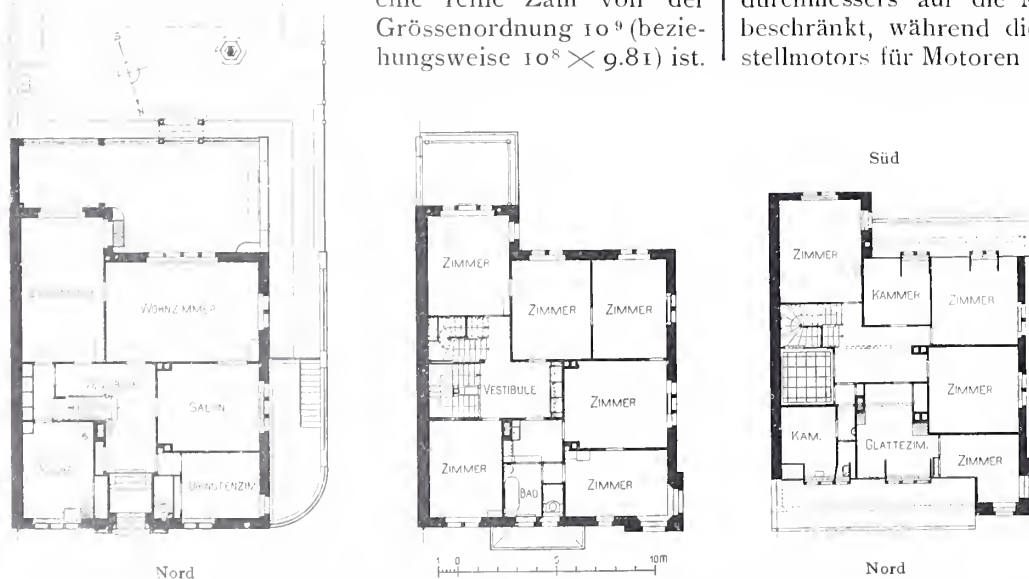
, 43 und 44. Grundrisse vom Erdgeschoss und den zwei Obergeschossen. — Masstab 1 : 400.
